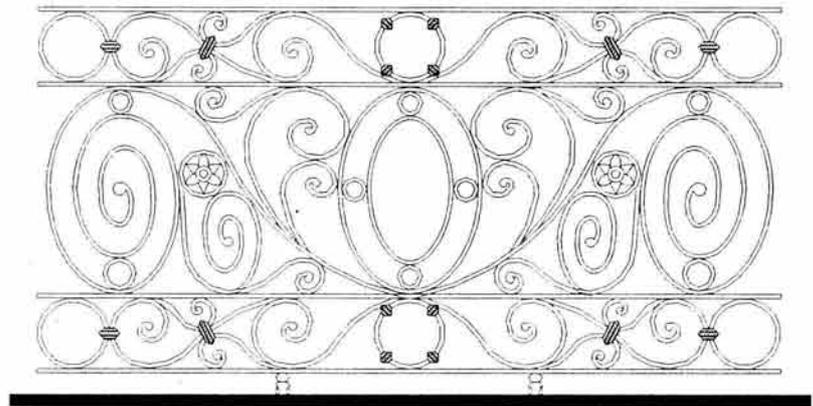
La herrería afrancesada registrada en el levantamiento del balcón de la planta alta, luce los elementos de plomo de las uniones y las flores de lámina recortada junto a la decoración profusa de su
